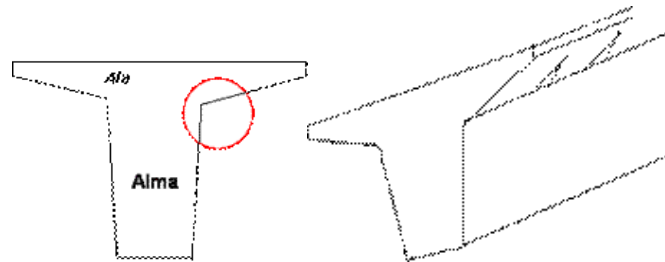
Fisuración por efecto de la contracción impedida
